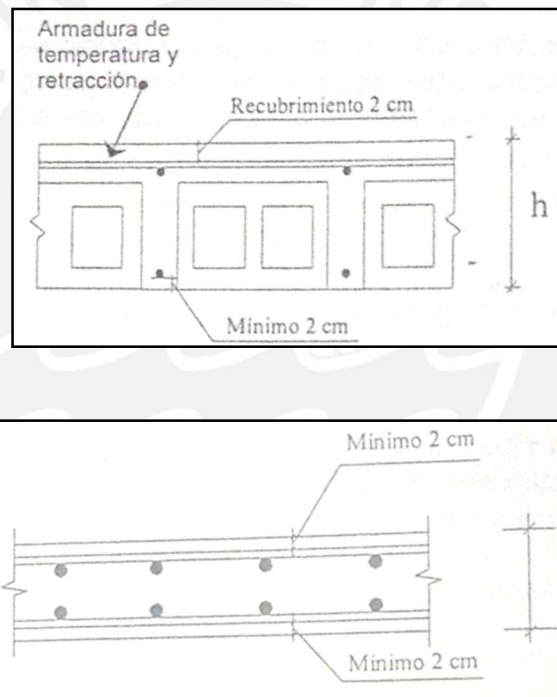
Recubrimiento en Aligerados y Losas Macizas (Fuente: Apuntes del Curso Concreto Armado 1, Ottazzi 2010).
